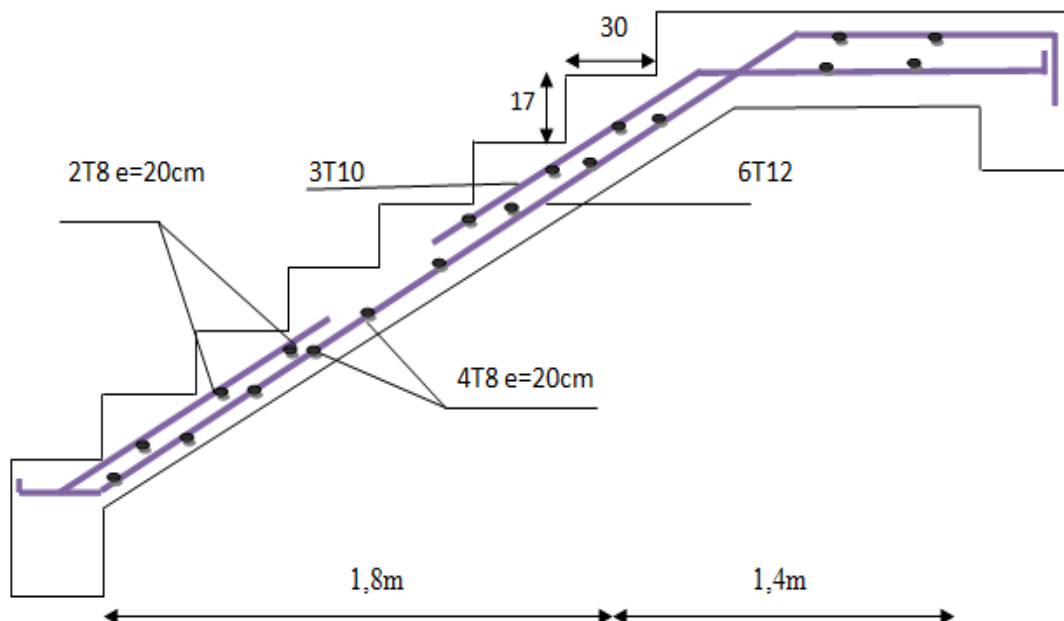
Schéma de ferrailages d'escaliers( types 1).
